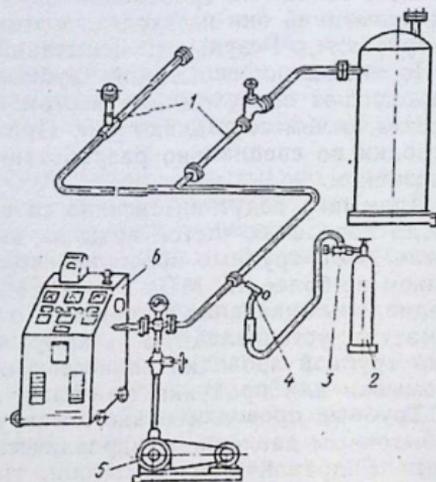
Схема испытания вакуумных трубных проводок теченскателем ПТИ-4А:
